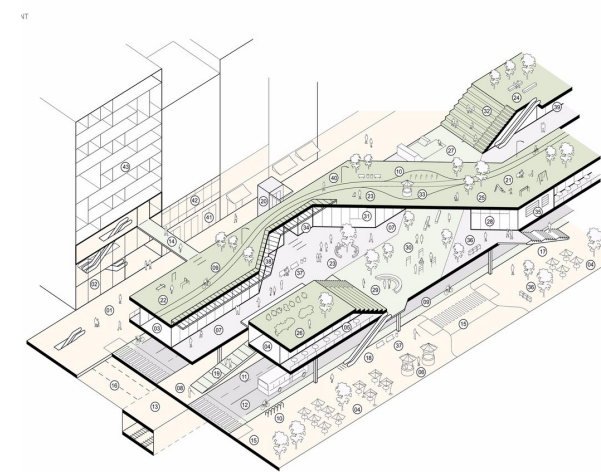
Parque Elevado Fuente: Plataforma Arquitectura
